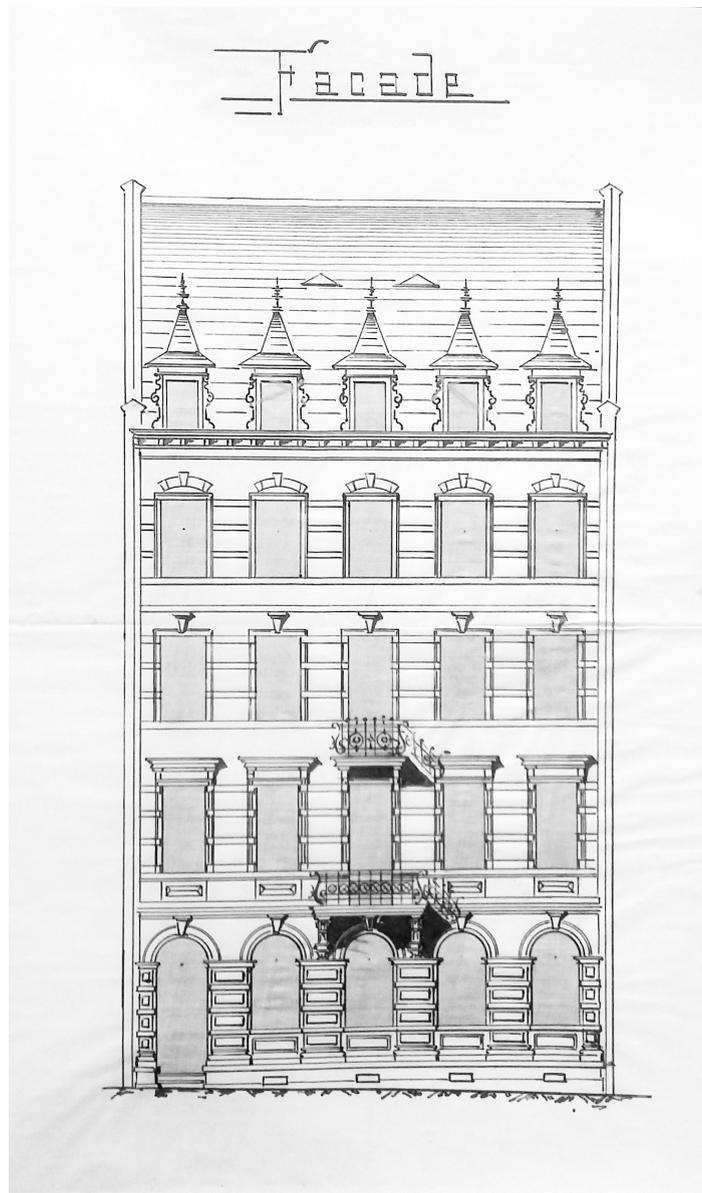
Fassadenansicht der Gärtnergasse 30 vor dem Wiederaufbau,
